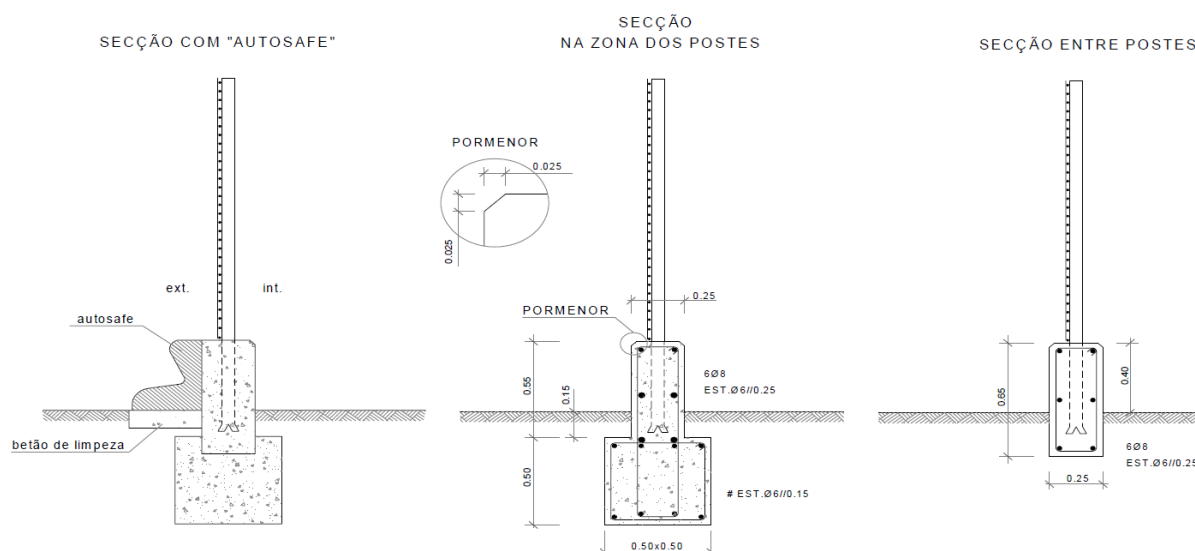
Geometria e pormenorização de armaduras do murete de apoio
